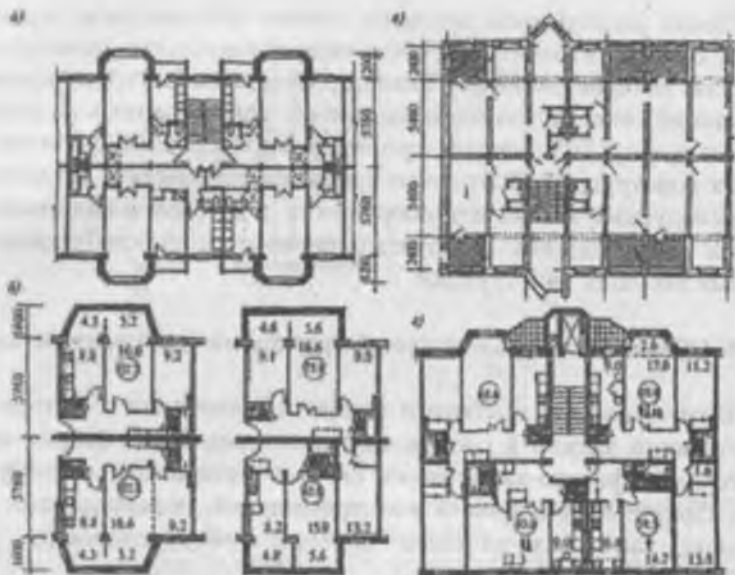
Примеры планировочных решений при реконструкции крупнопанельных зданий:
